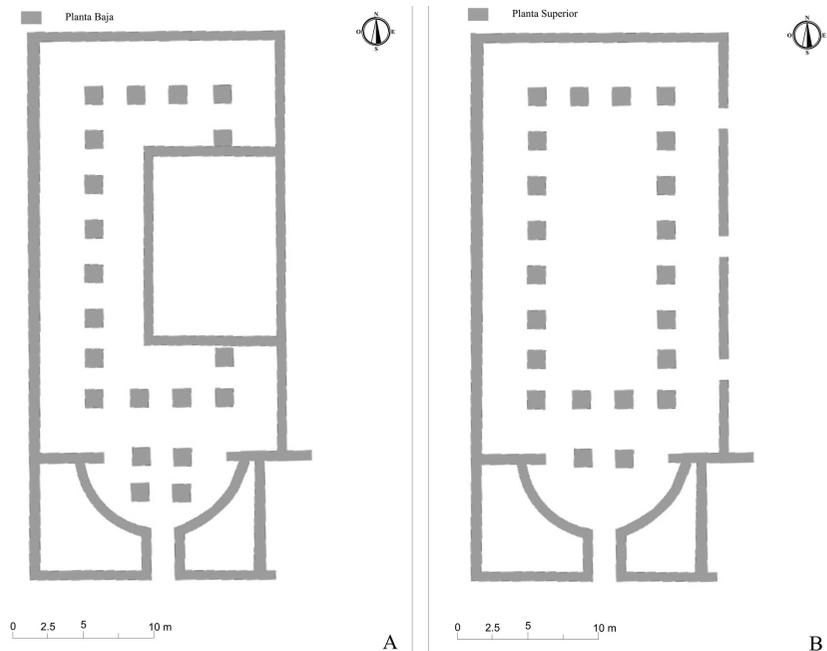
Planta del edificio basilical: A) planta del criptopórtico; B) planta principal de la basílica.
